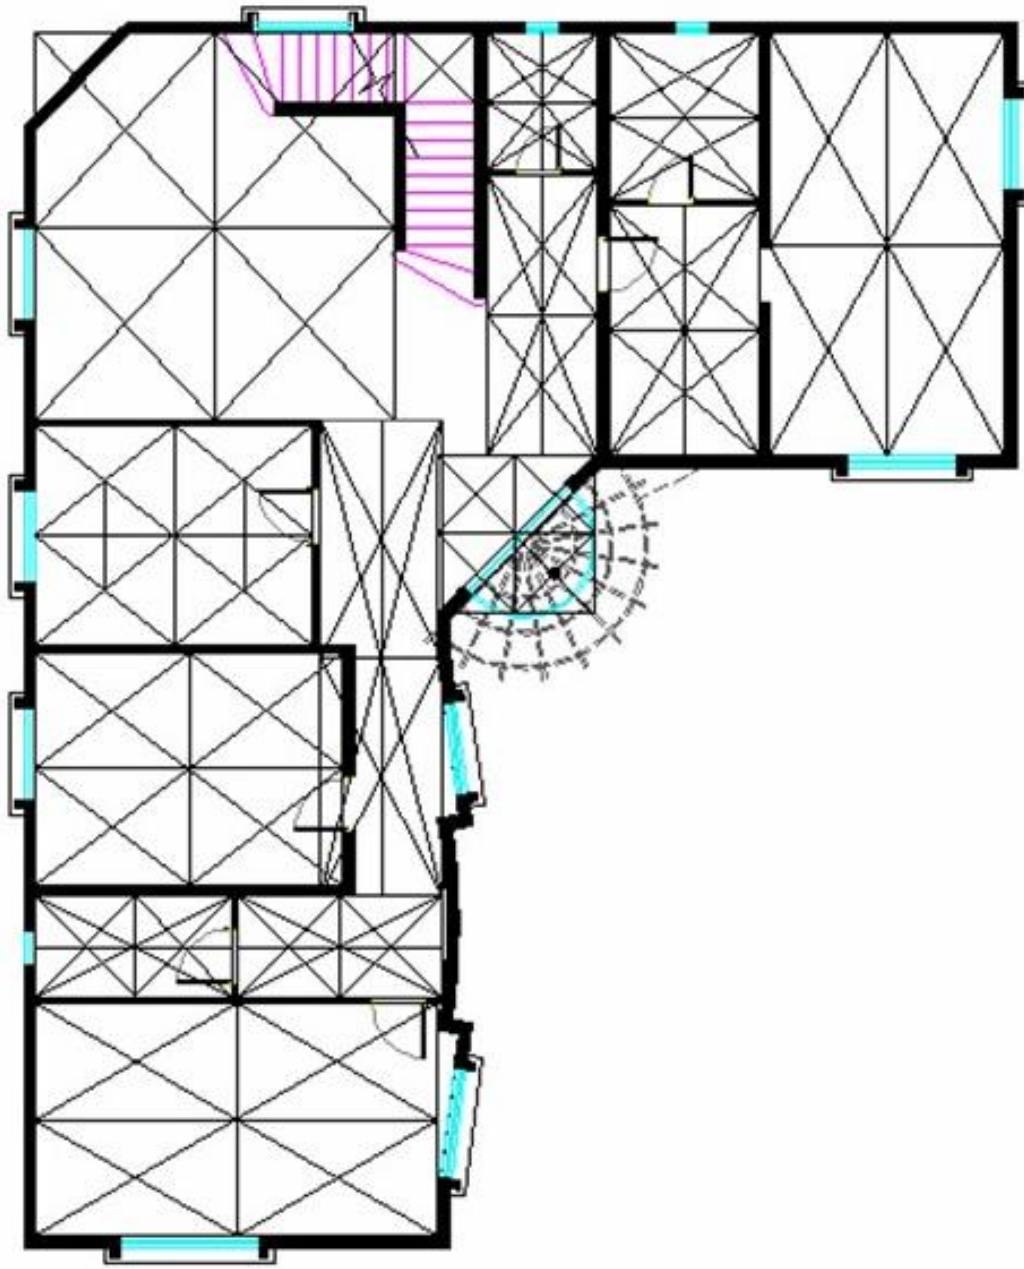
أ) مسقط أفقي للدور الأول
